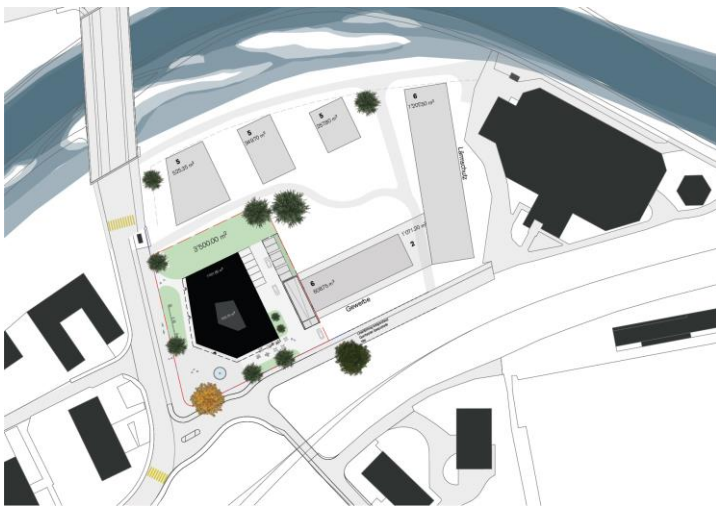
Überprüfung einer Bebauung des Gesamt-Areals Nau, Variante 3: grossmassstäbliche Baukörper
